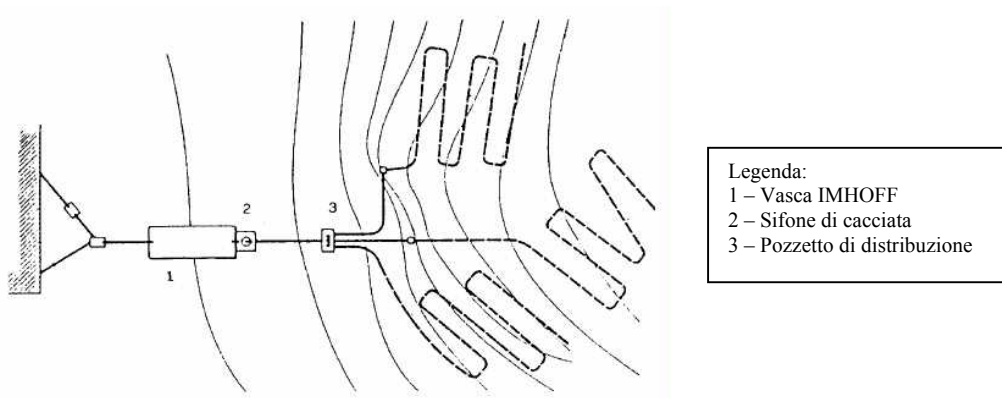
Andamento planimetrico delle condotte di sub-irrigazione
